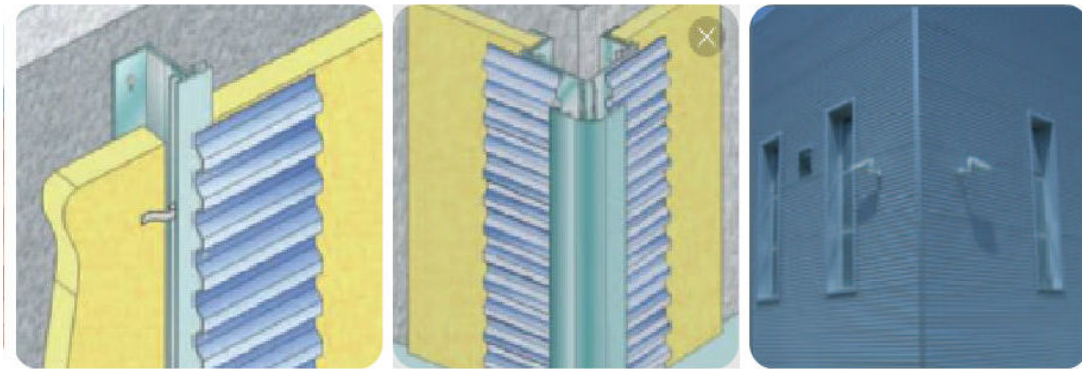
Detalhes de junta e remates | Edifício com sistema de fachada ventilada com alumínio perfilado [14]
